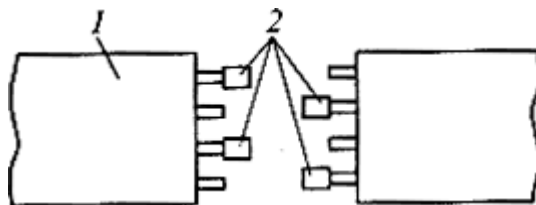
Расположение шин при стыковке секций троллейного шинопровода:
